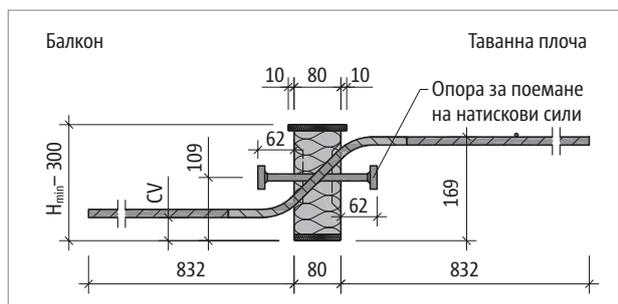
Schöck Isokorb® T тип QP-V6: Сечение на продукта
